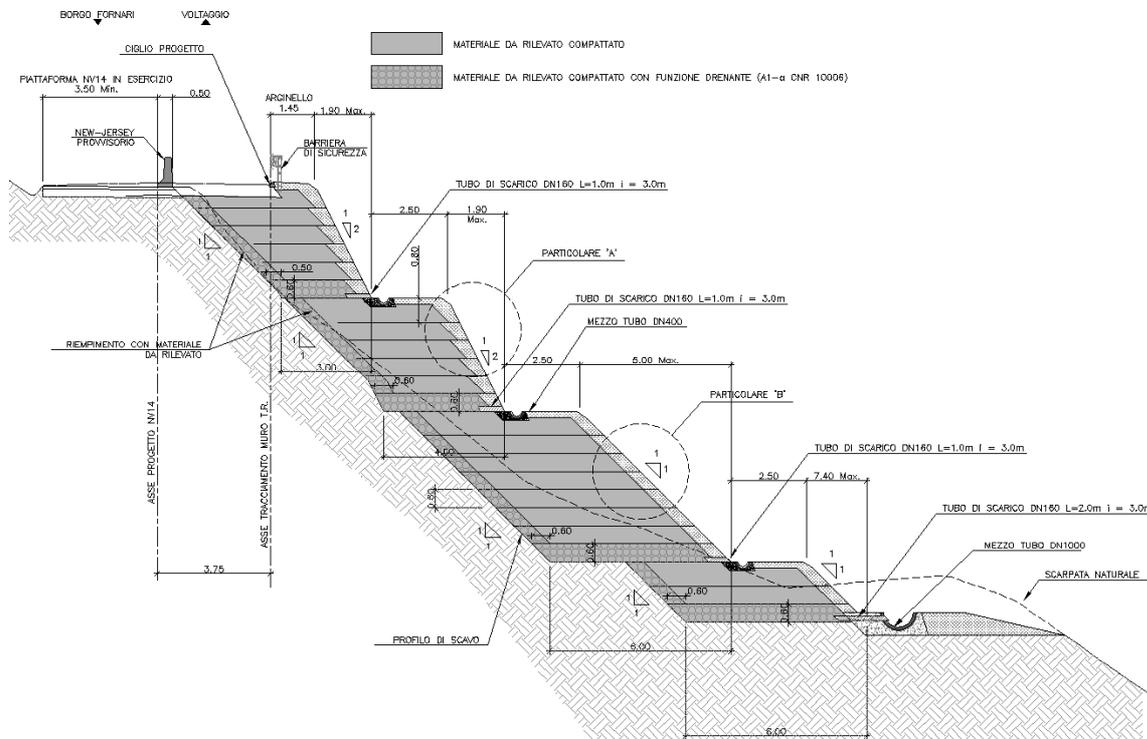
Sezione tipica muro di sostegno in terra rinforzata
